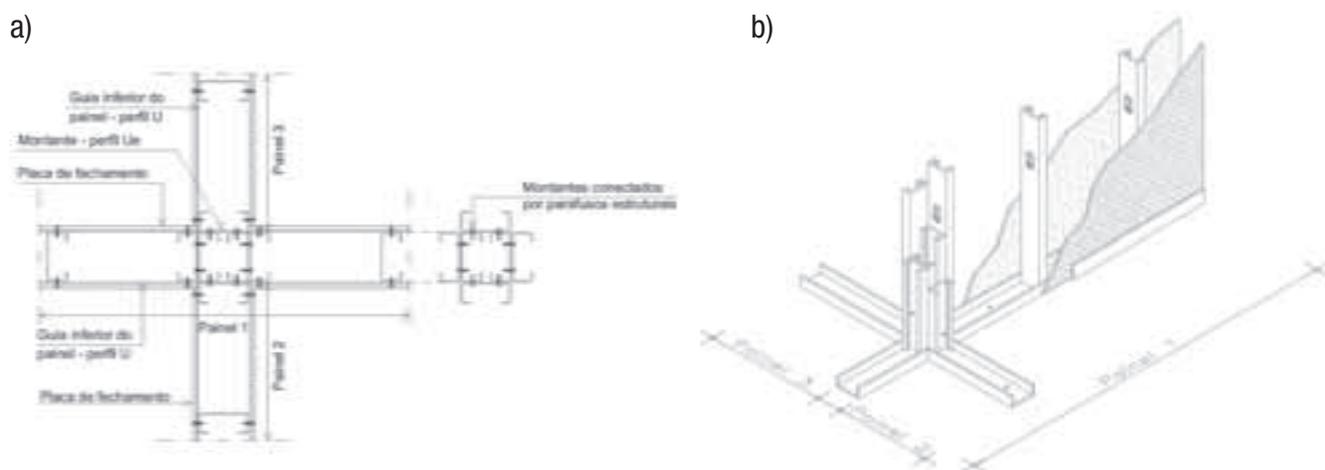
Encontro de três painéis: a) planta b) perspectiva
